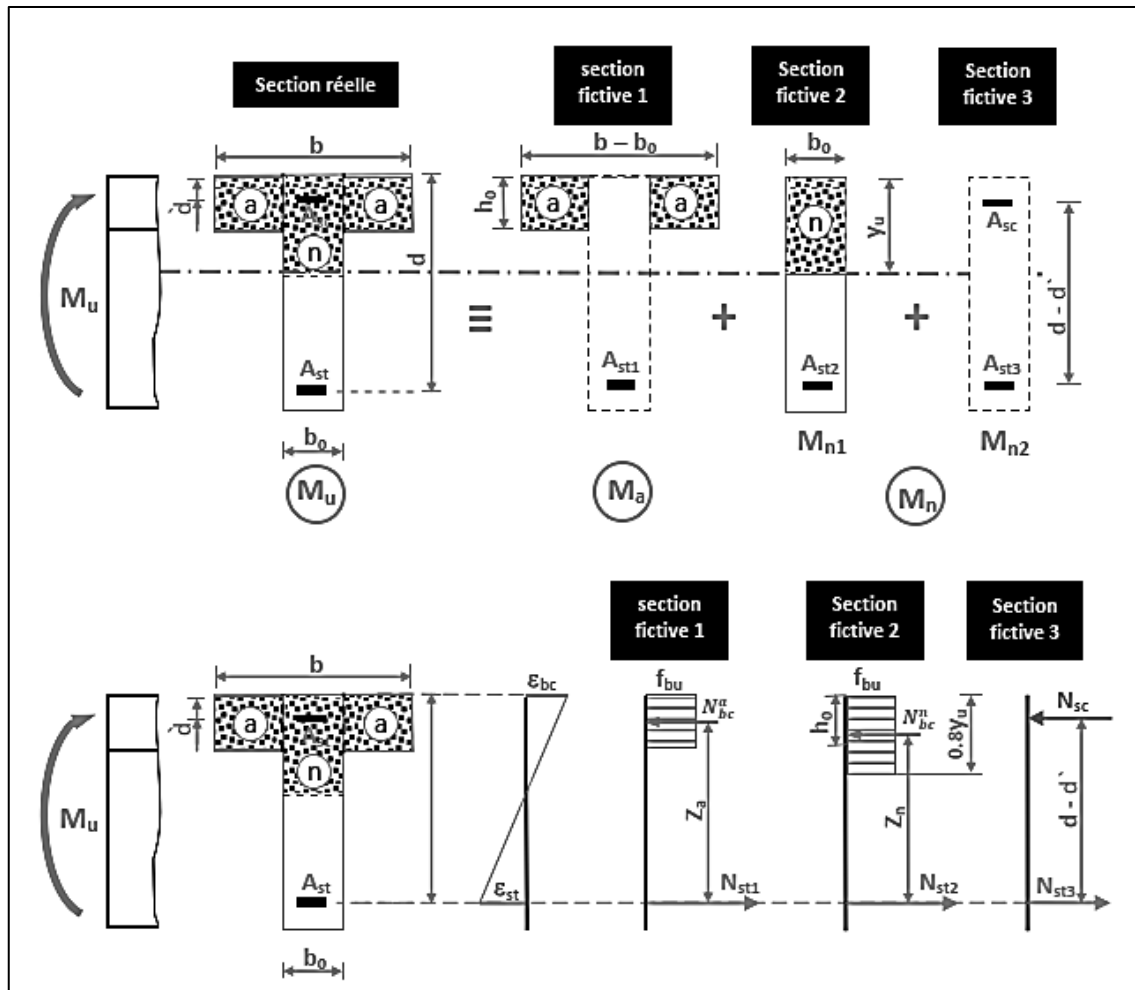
Principe de calcul à l'ELU d'une section en T avec aciers comprimés
